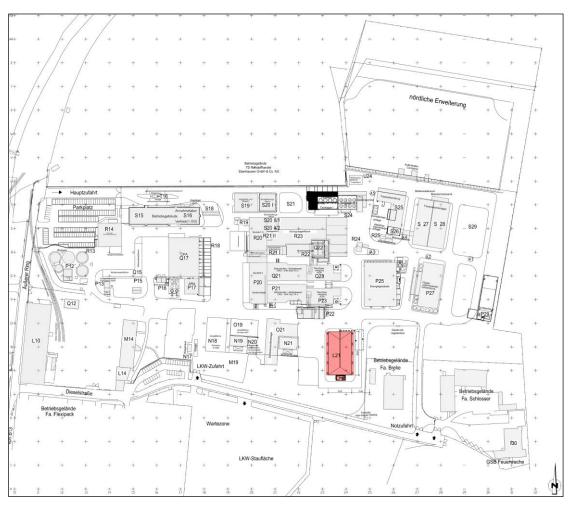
Lageplan der geplanten Stückgutabstellfläche L21 (Quelle: IA-Tech GmbH)
